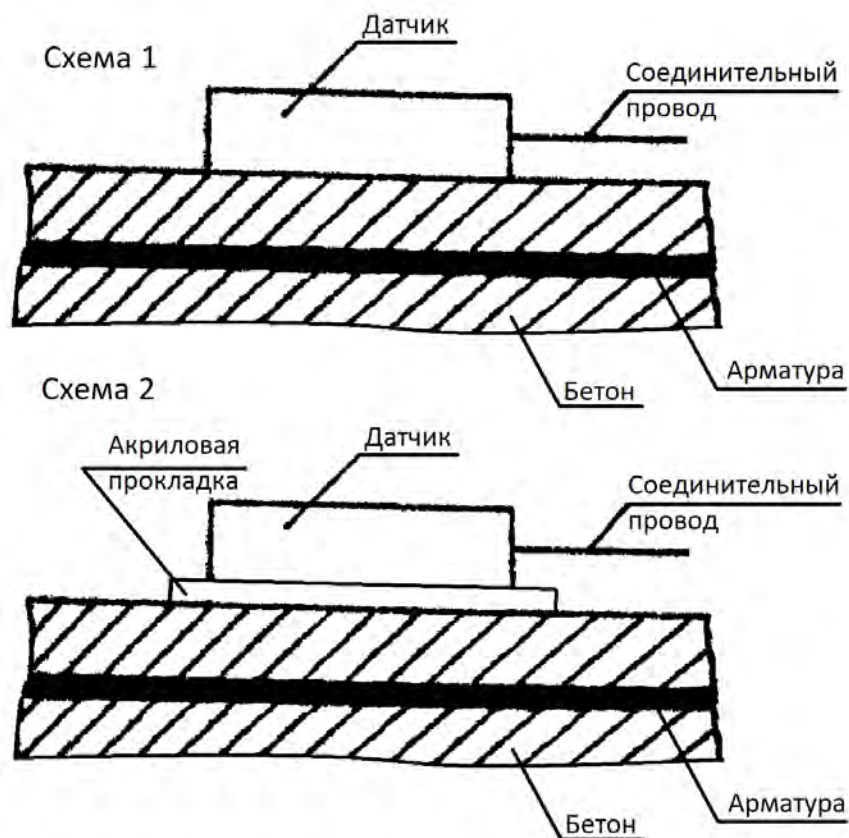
Определение параметров армирования при помощи прибора ИПА МГ-4. Схема 1 – без прокладки. Схема 2 – с акриловой прокладкой
